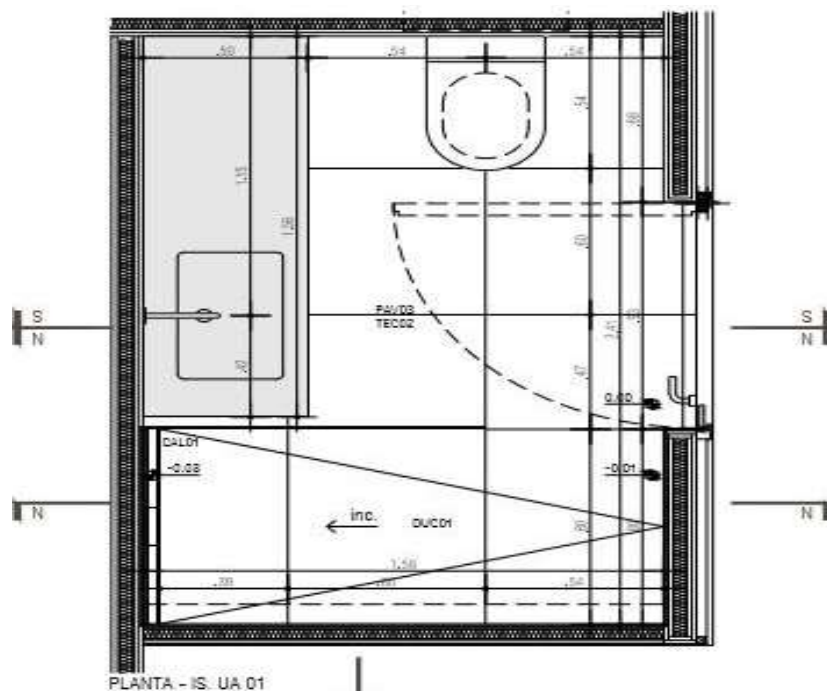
Planta da IS, com a estereotomia de pavimento [5]
